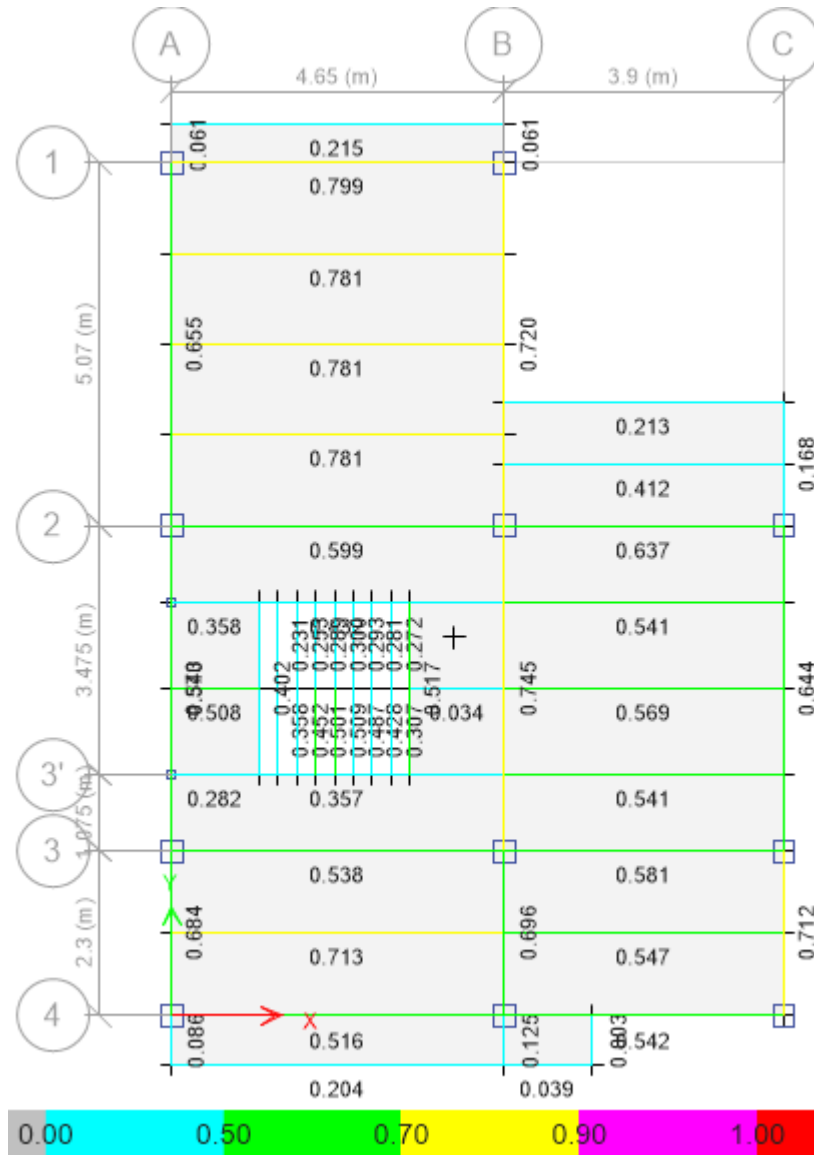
Diseño de vigas principales y secundarias de la losa del nivel +3.06, de la estructura con columnas de acero compuestas
